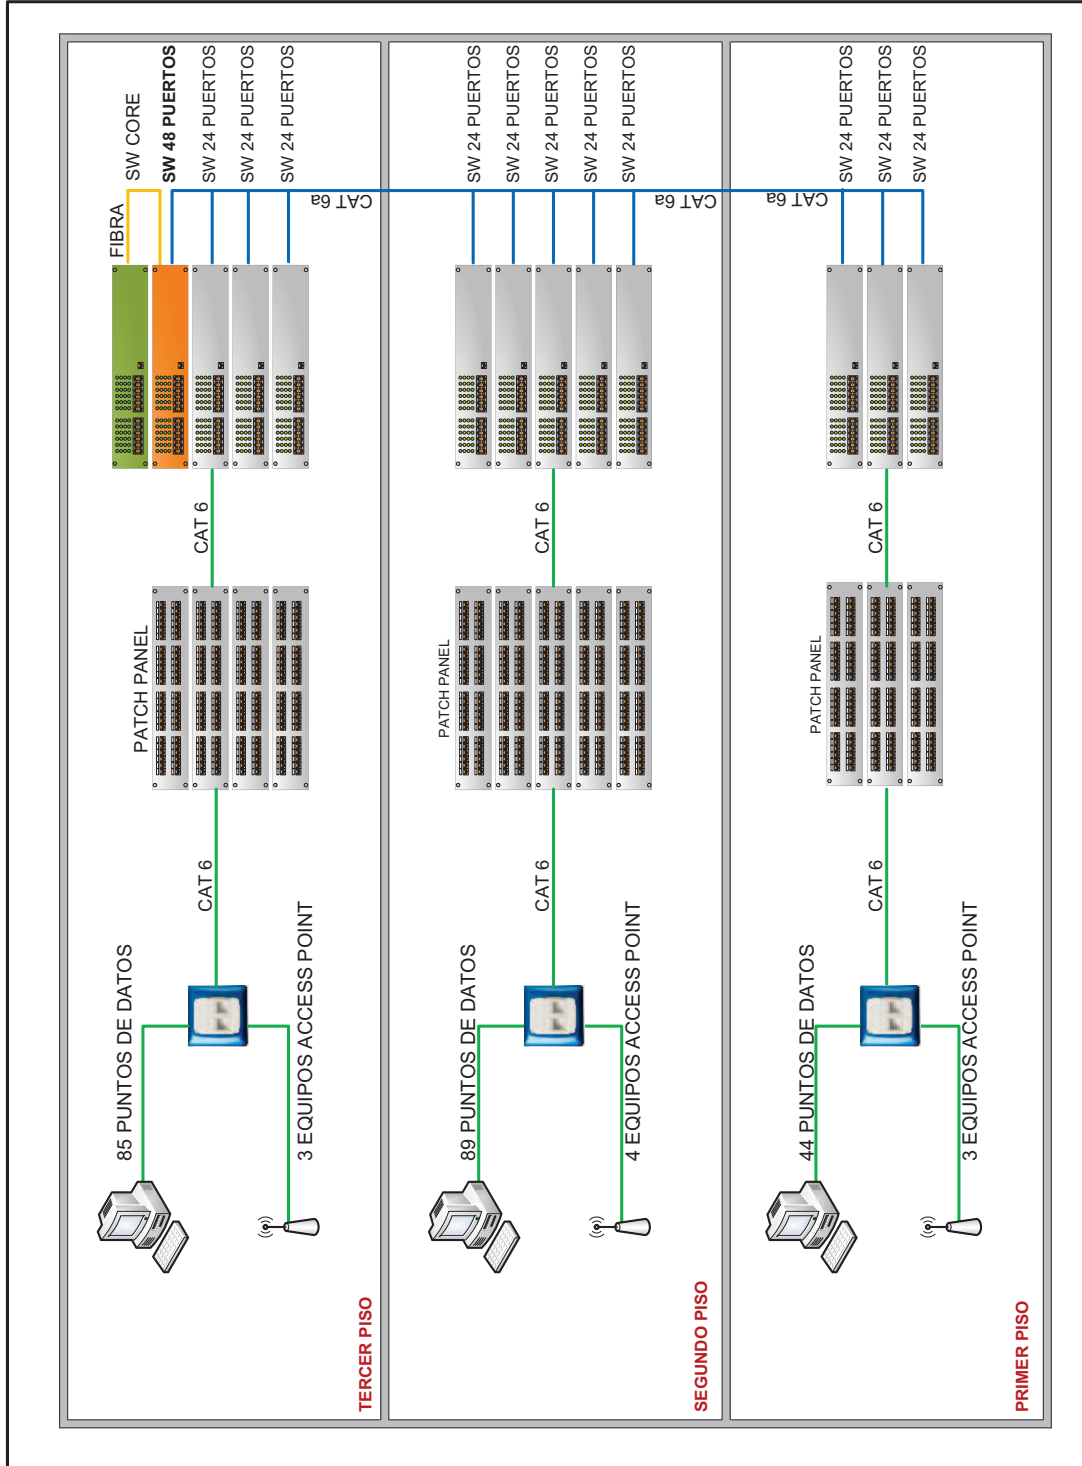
Cableado horizontal y vertical en el edificio Central - lado sur
